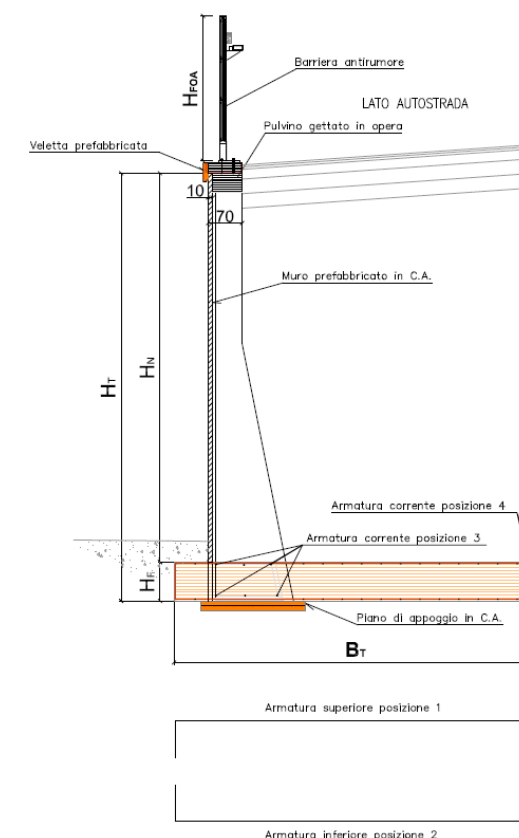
Sezione tipologica del muro di sostegno prefabbricato
